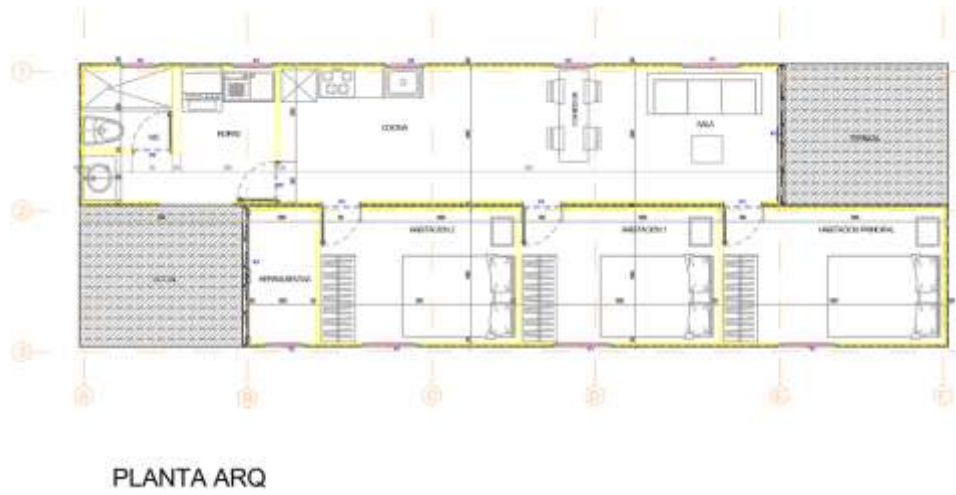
, planta Arquitectónica, 2025-II, Wilson Lozano
